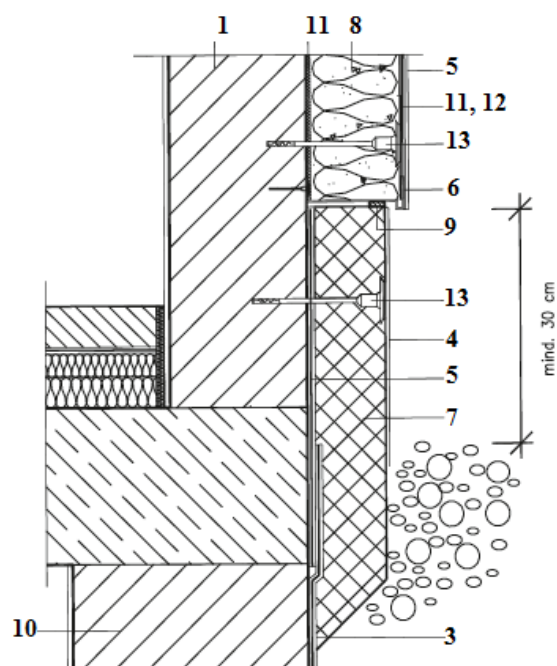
Изоляция цоколя с упругой изоляцией по периметру: 1 — кирпичная кладка; 2 — наружная штукатурка; 3 — изоляция подвального помещения; 4 — штукатурка для цоколя; 5 — гибкие гидроизоляционные смеси; 6 — замыкающий штукатурный профиль; 7 — изоляция по периметру; 8 — минеральная изоляционная плита; 9 — предварительно сжатая уплотнительная лента; 10 — имеющаяся кирпичная кладка; 11 — легкий раствор; 12 — армирующая сетка; 13 — тарельчатый винтовой дюбель
